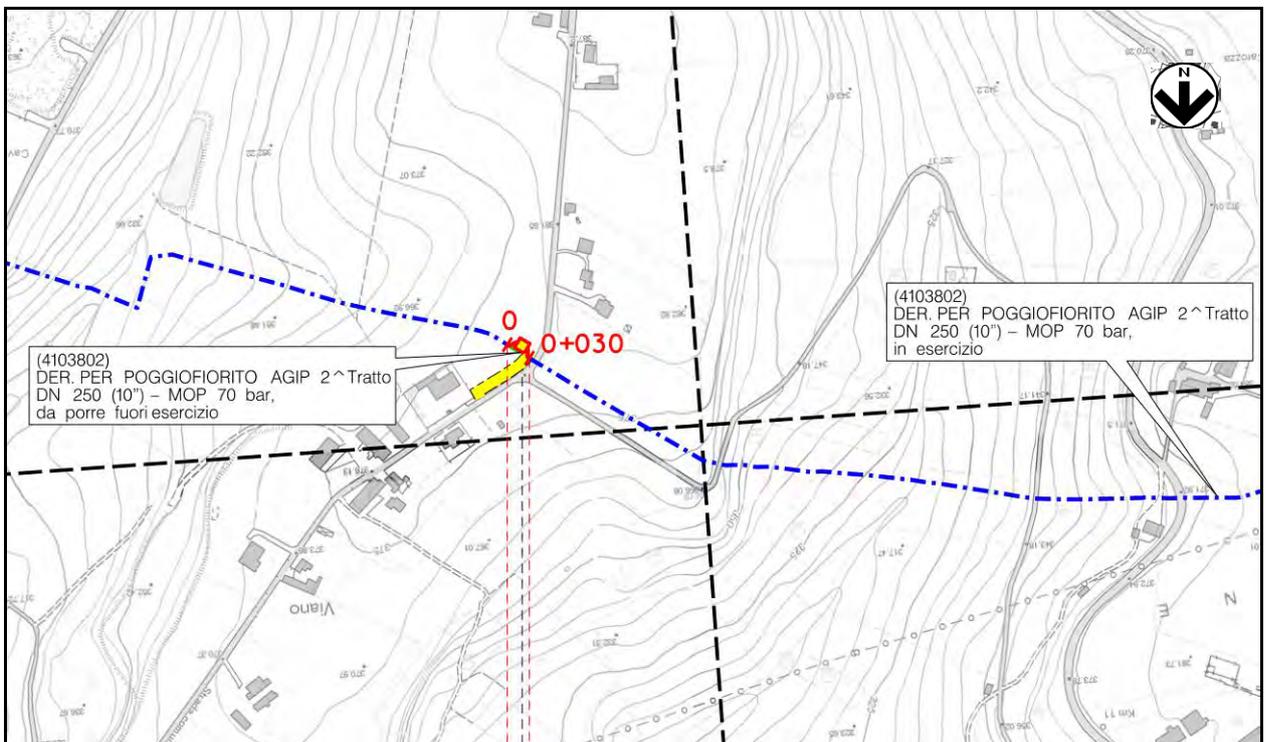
/D.b – Planimetria 1:5.000 con localizzazione dell'area dell'Intervento n.3 (progetto in rosso, dismissione in verde, esistente in blu)
